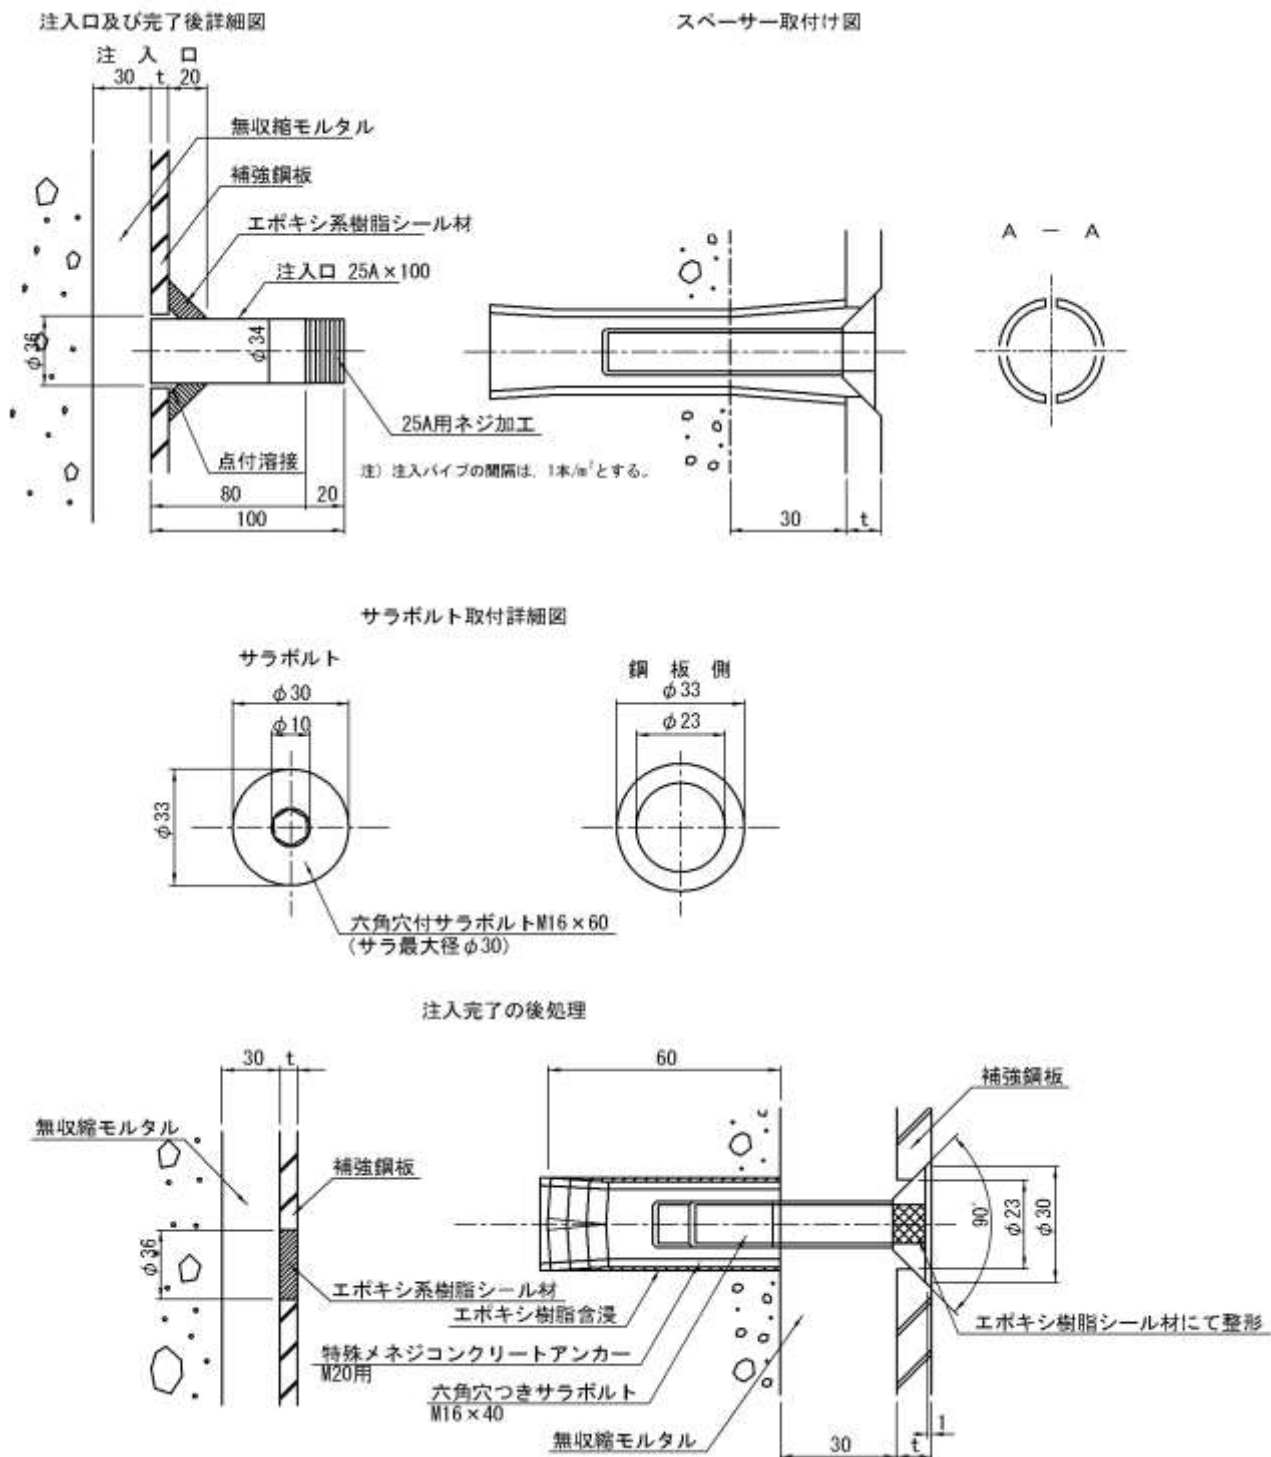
鋼板巻立て工法各部詳細図 (2)
